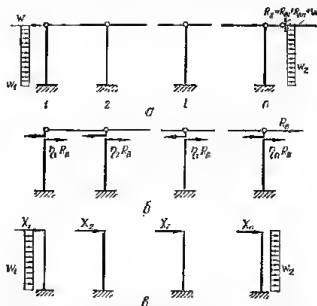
Расчет многопролетного поперечника на ветровую нагрузку:
